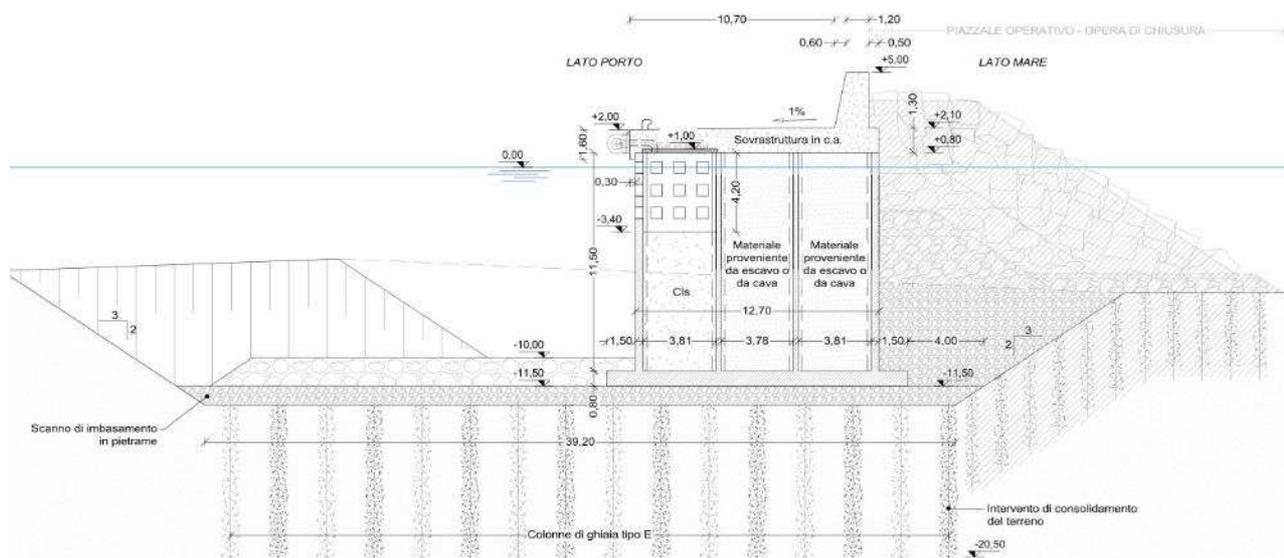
Cassone n°2 (protetto da Opera di Chiusura): sezione tipo
